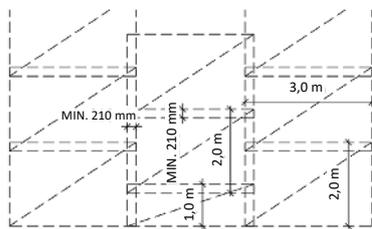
## DETAILS DER VERLEGUNG DER BEWEHRUNG – GRUNDRISS
